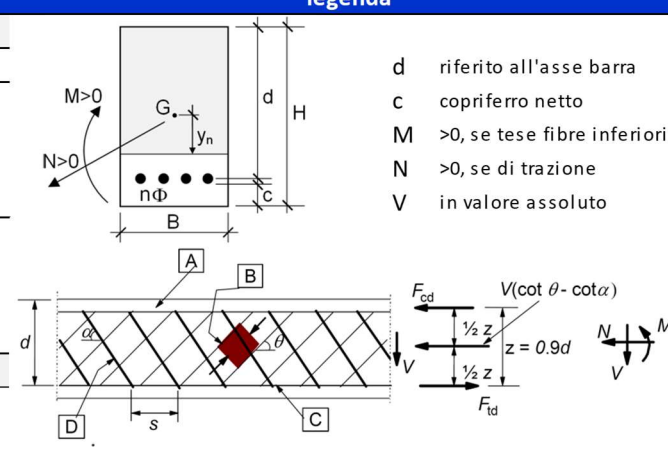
Sezione tratto A-A – Verifica strutturale del paramento in c.a.
